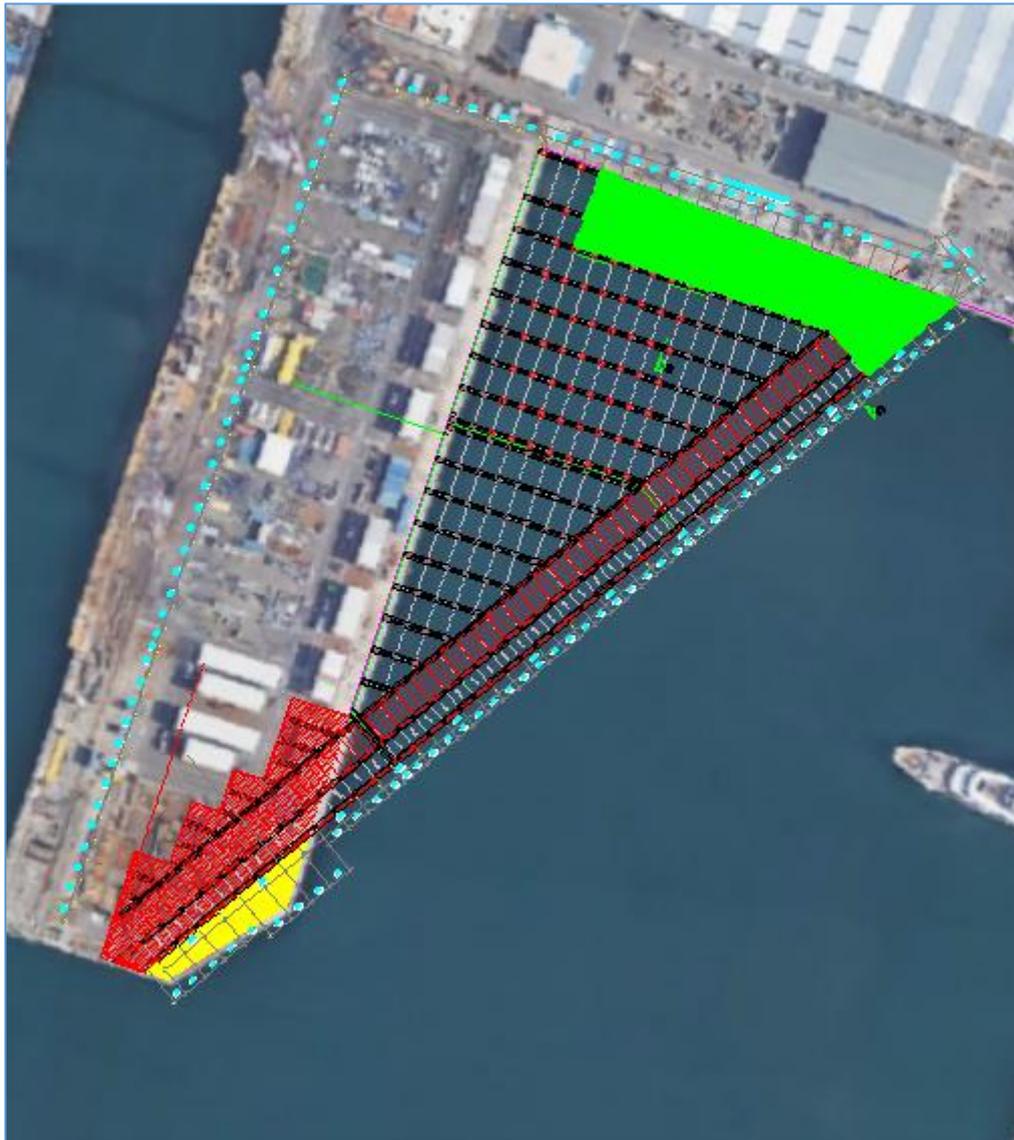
Pianta delle strutture previste per l'ampliamento del nuovo molo Fincantieri
